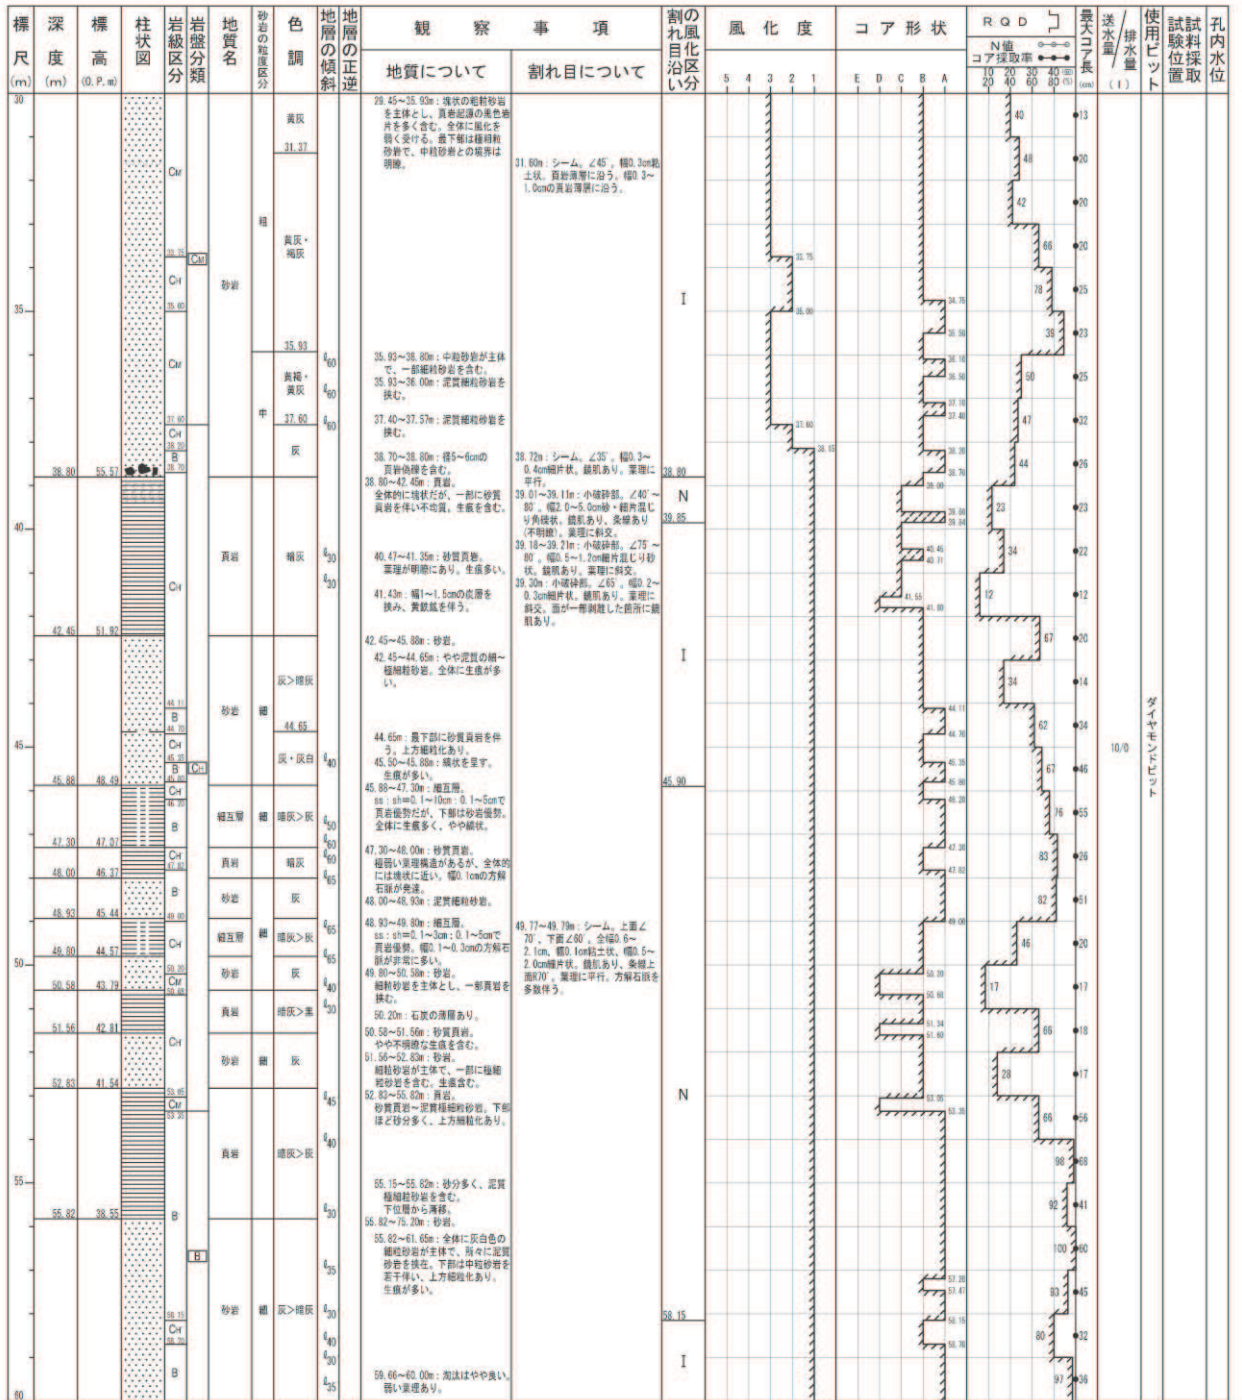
(3) ボーリング柱状図 (26NPB-4) (深度 30~60m)
